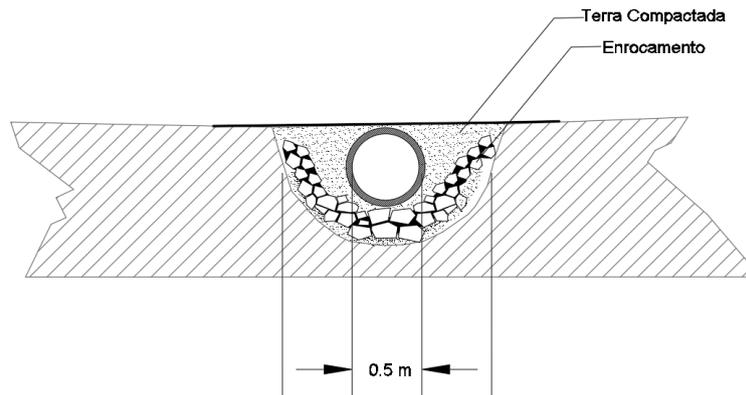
Pormenor tipo para o emalilhamento da travessia da vala de drenagem.
